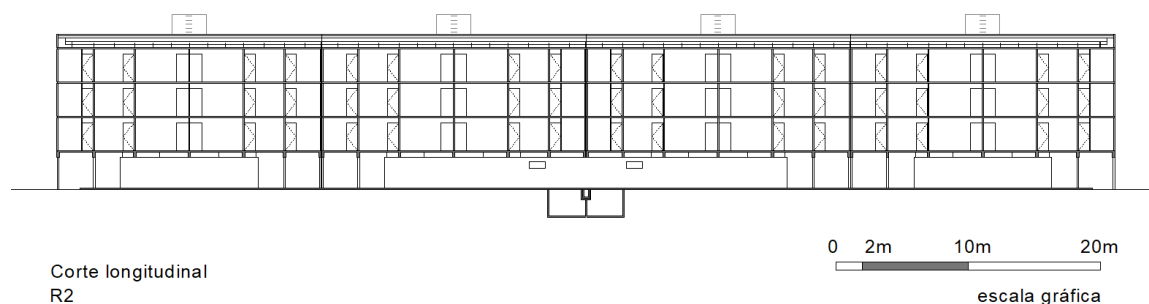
Corte Longitudinal do R2. Fonte: da autora, adaptado das pranchas originais do Acervo do Arquiteto Milton Ramos.
